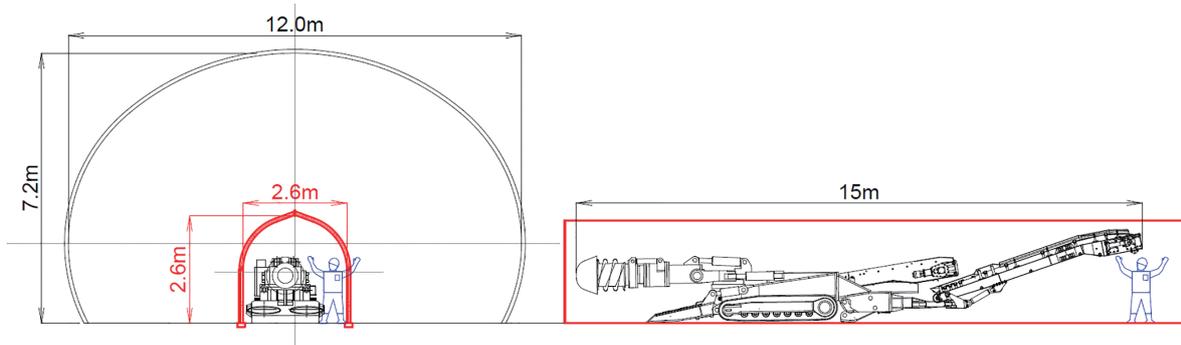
底原トンネル標準断面図, 100 kW 級自由断面掘削機 : 32 t
